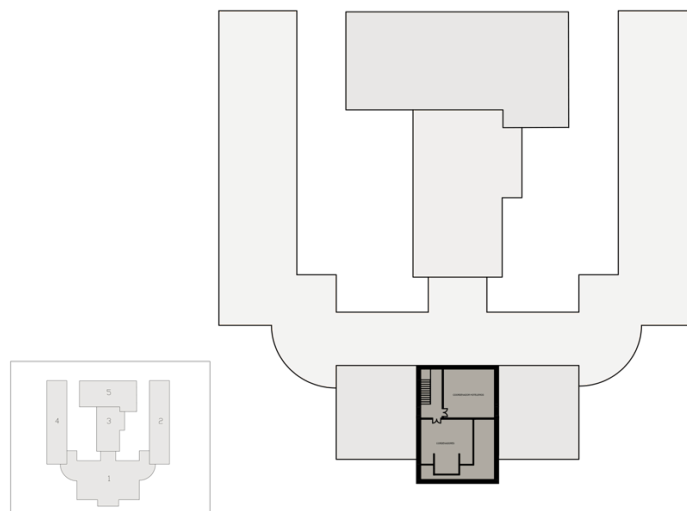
Segunda planta bloque 1. Análisis de usos. En marrón área de acceso restringido a personal autorizado. Plano base oficial facilitado por el Ingeniero Paulo Costa. Análisis gráfico realizado por Laura Castro.
